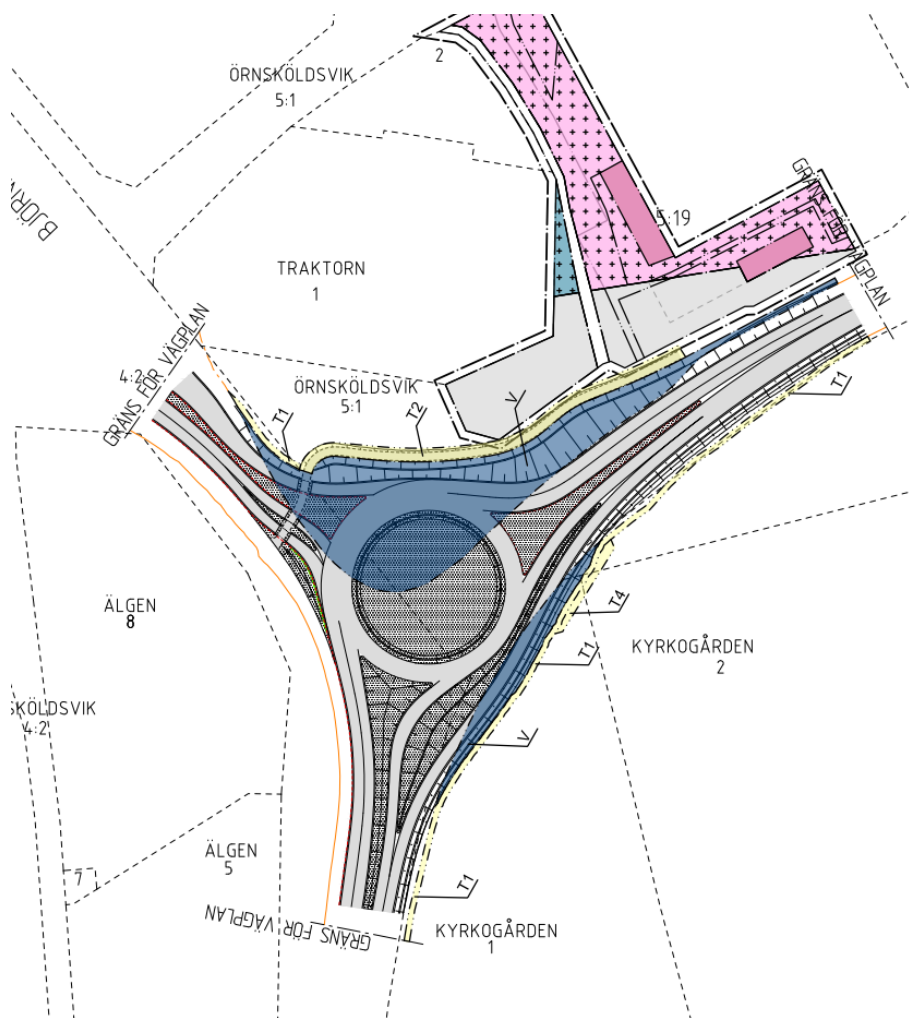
Detaljplan 2284K-P09/0416/1 med planförslaget. (Ej skalenlig)
